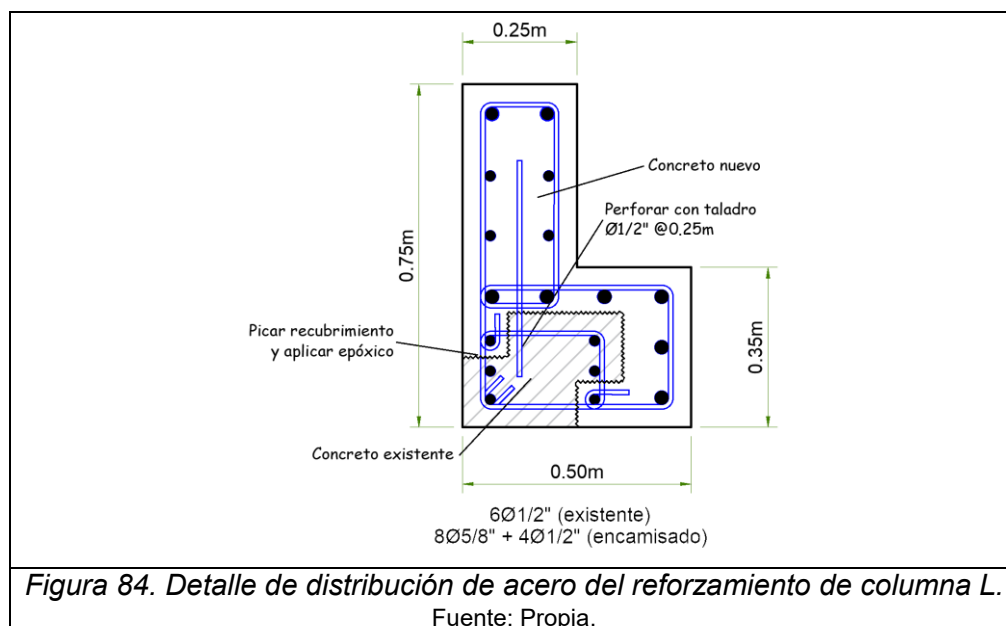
Detalle de distribución de acero del reforzamiento de columna L.
